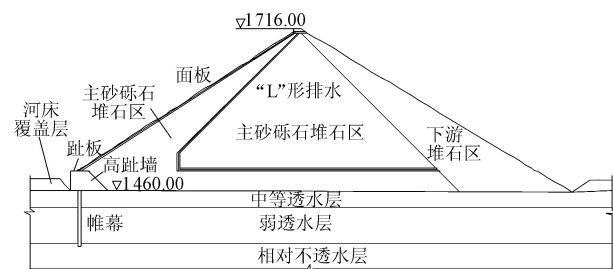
混凝土面板砂砾石坝坝体标准剖面(单位:m)
